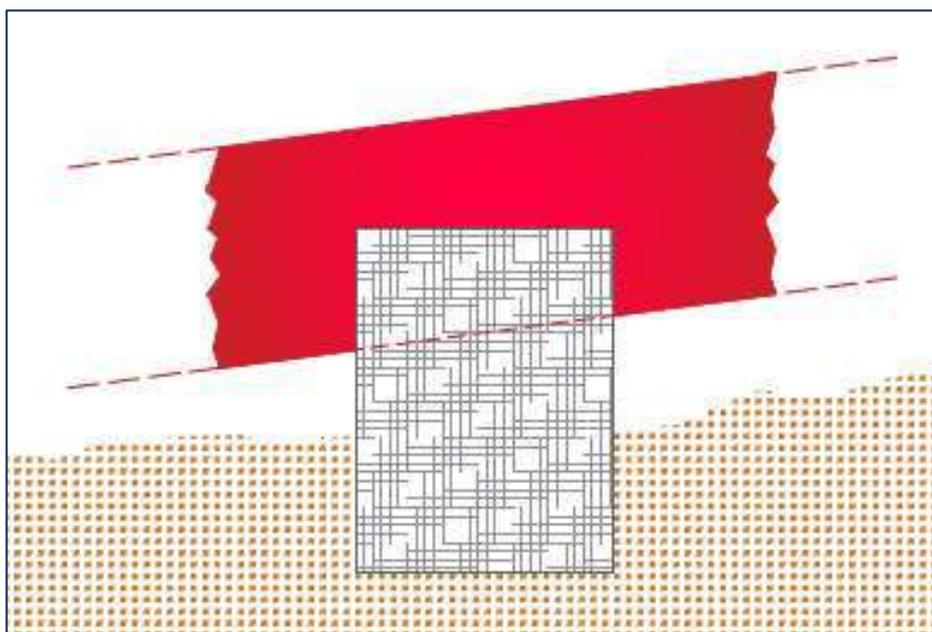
14: DETALLES DE LA TUBERIA FORZADA DE TINGO – VISTA TRANSVERSAL
